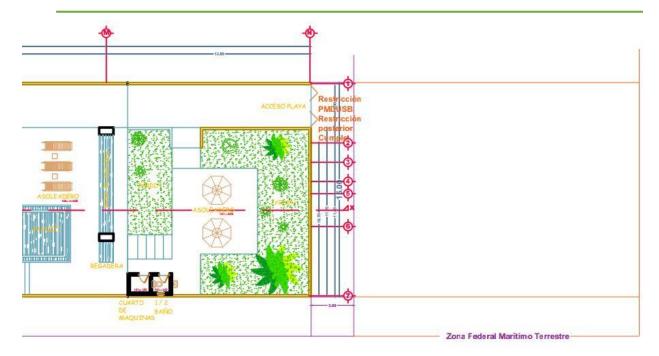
Detalle del diagrama del proyecto a construirse parte 2
